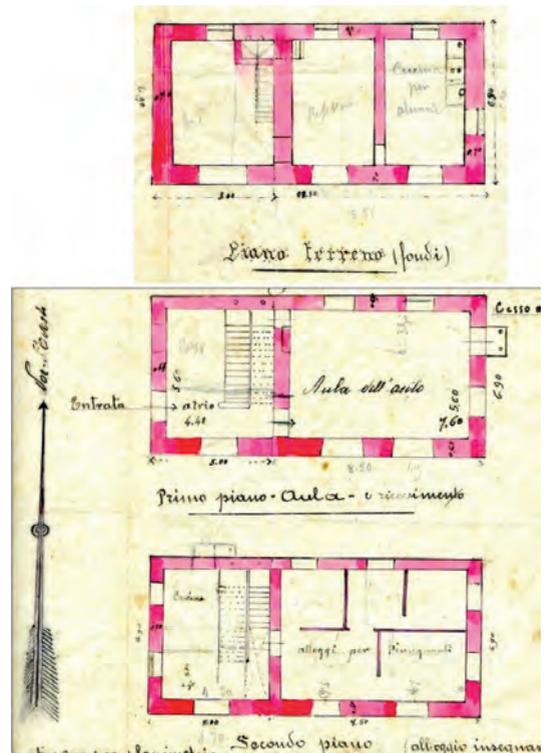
Pianta e prospetto. Dall'alto in basso: Piano terreno (fondi); Primo piano (Aula e ricevimento); Secondo piano (alloggio insegnanti).
